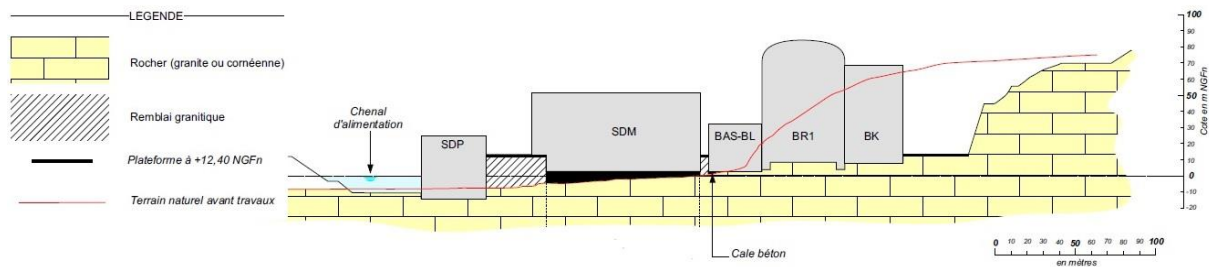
c : Coupe schématique du sous-sol – Après construction du site
